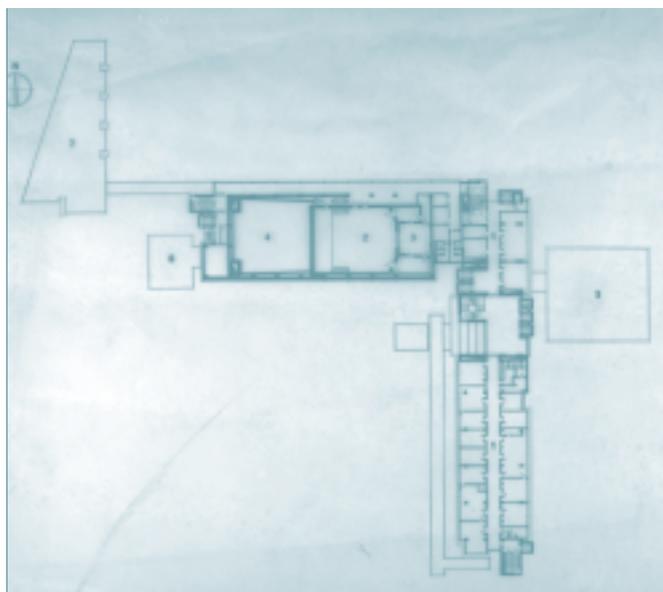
Planimetria del piano primo della Zona radio e del piano secondo della Zona uffici (ASF)
